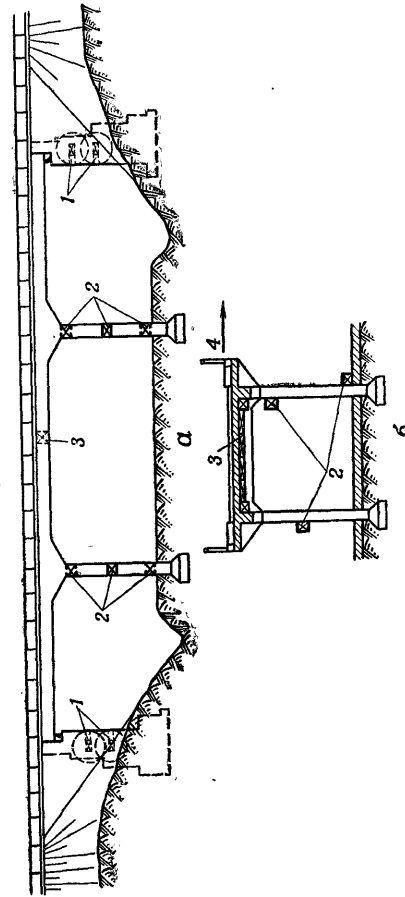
Подрывание железобетонного путепровода рамной конструкции: *a* — вид сбоку; *б* — поперечный разрез; 1 — заряды для подрывания устоев по косым сечениям; 2 — заряды для подрывания пролетного строения; 3 — заряды для подрывания стоек; 4 — направление обрушения
